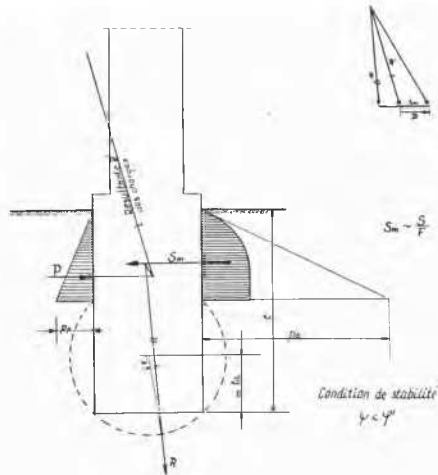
Schéma de calcul de stabilité d'une fondation.
